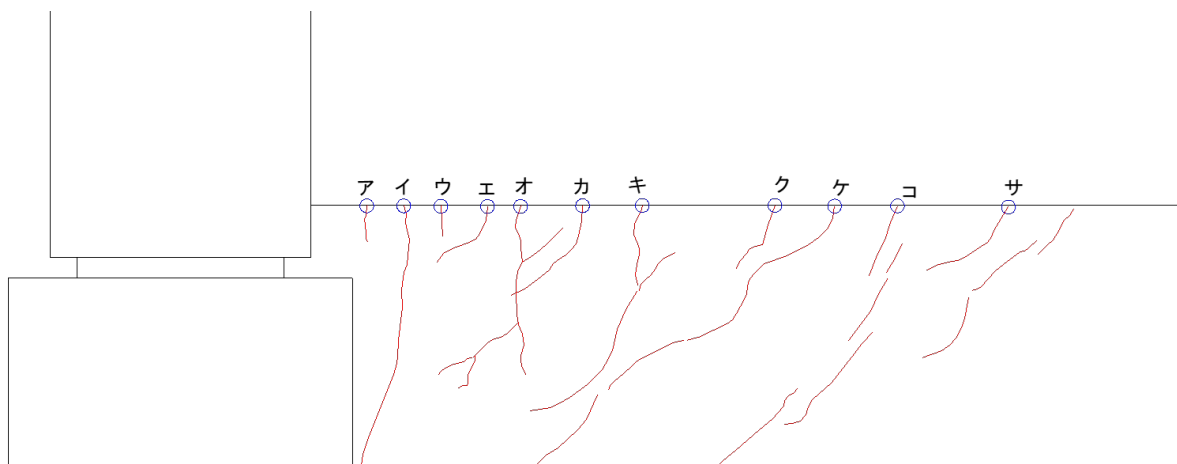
基礎梁ひび割れ幅測定位置 (試験体 A-3 負荷荷)
